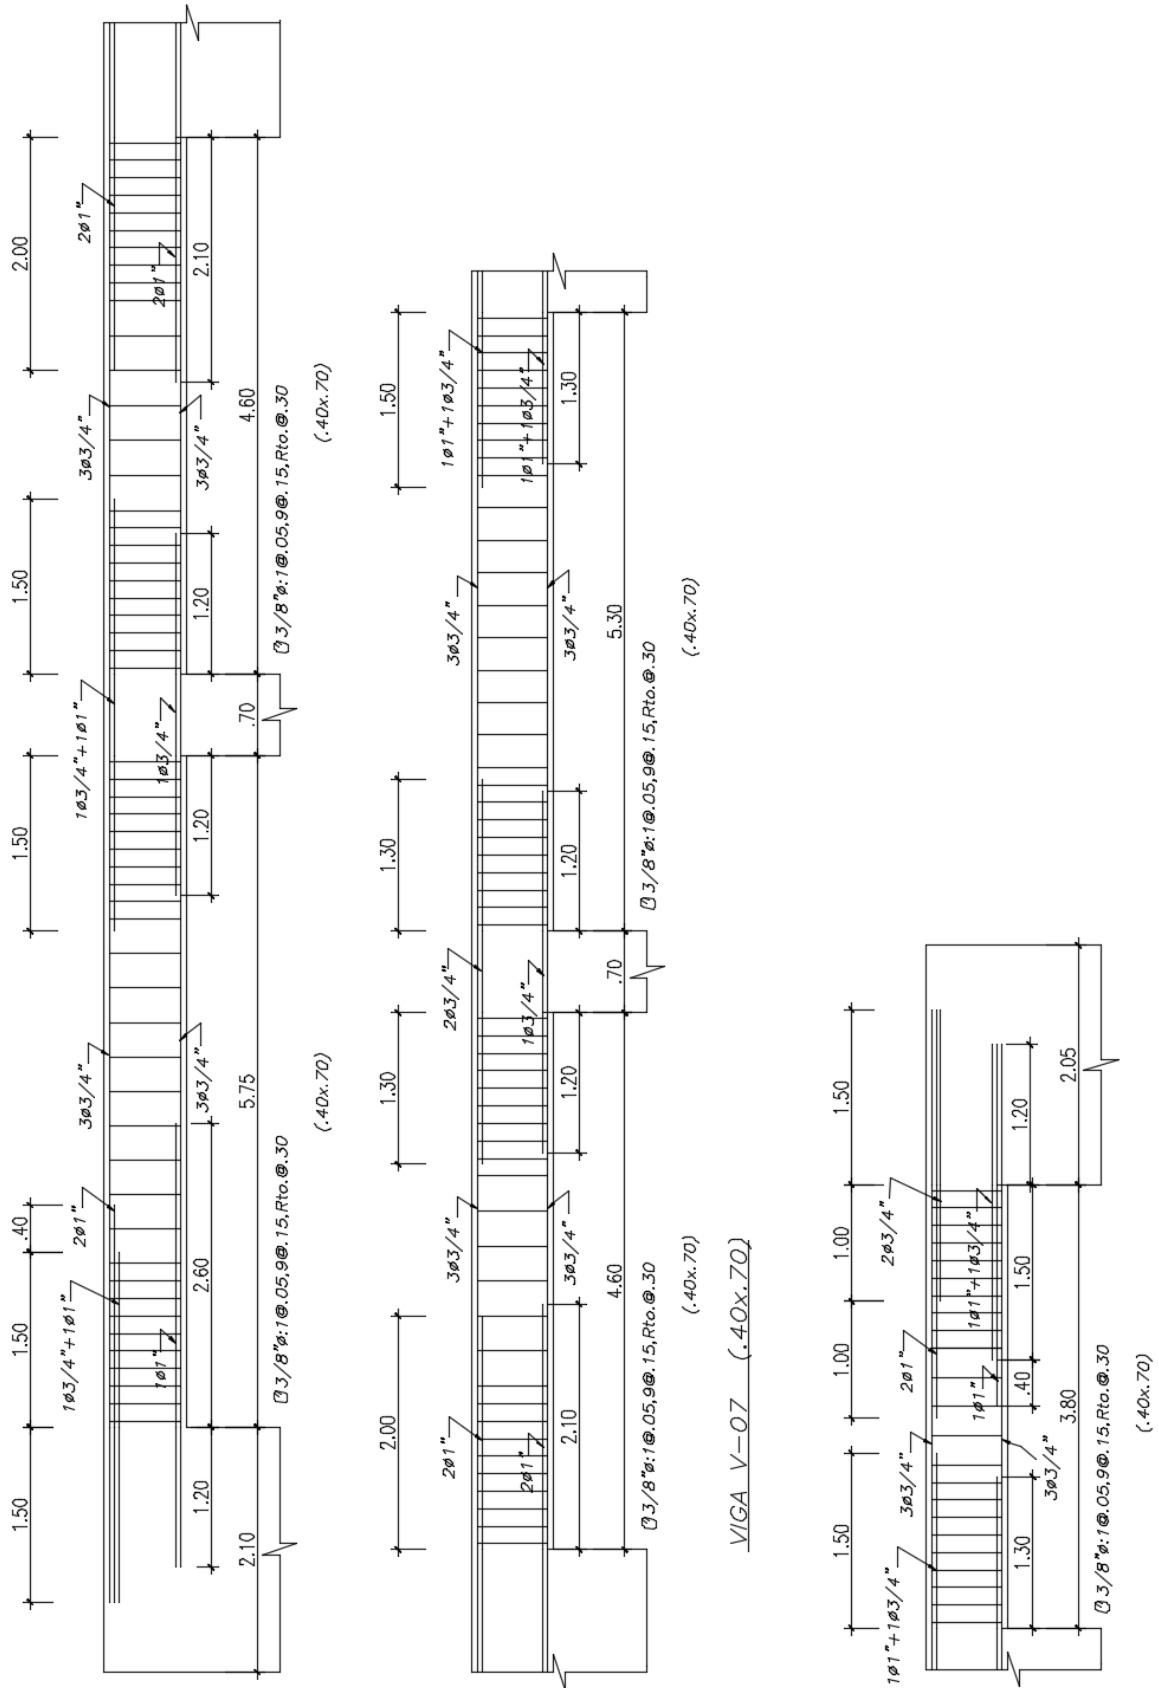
Distribución de acero longitudinal y transversal en la viga V-07
